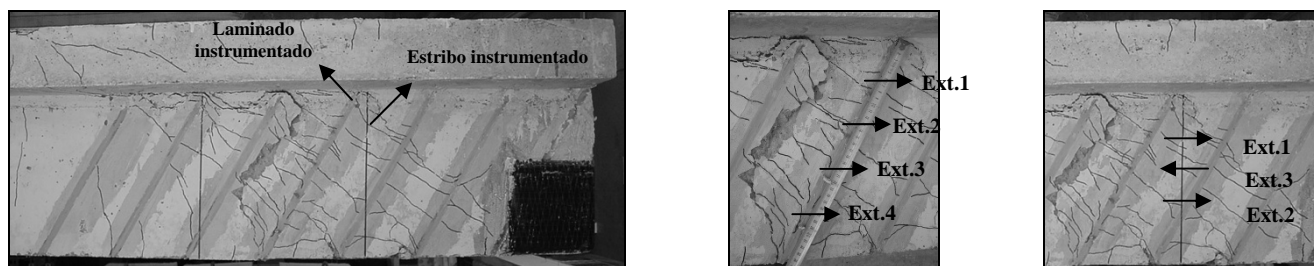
Localização dos extensómetros no laminado e estribo instrumentados da viga 2S-7LI60-A.
